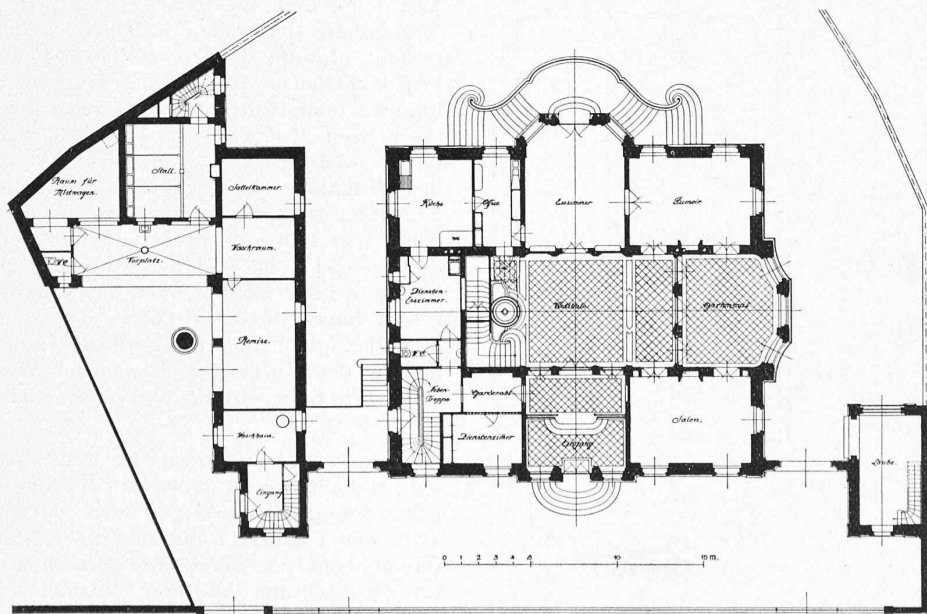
Grundriss vom Erdgeschoss des Wohnhauses und des Stallgebäudes. — Masstab 1:400.
